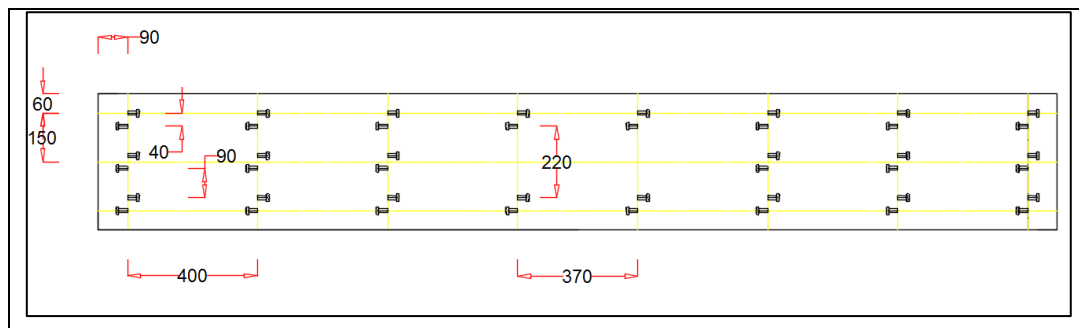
Espaciamiento y disposición de tirafondos para la losa en flexión. (Vista en planta)
